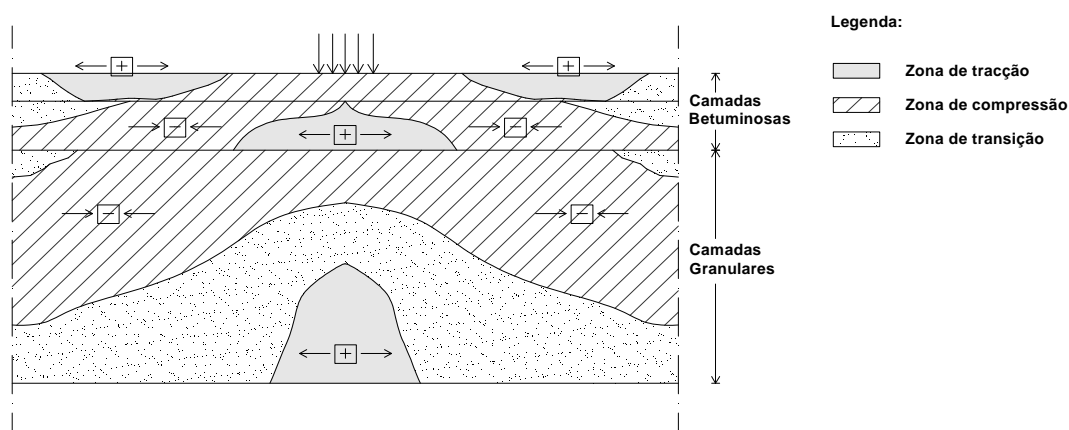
Zonas de tracção e compressão horizontal de um pavimento rodoviário sujeito à passagem de um rodado de um veículo (adaptado de Castell *et al.*, 2000)
